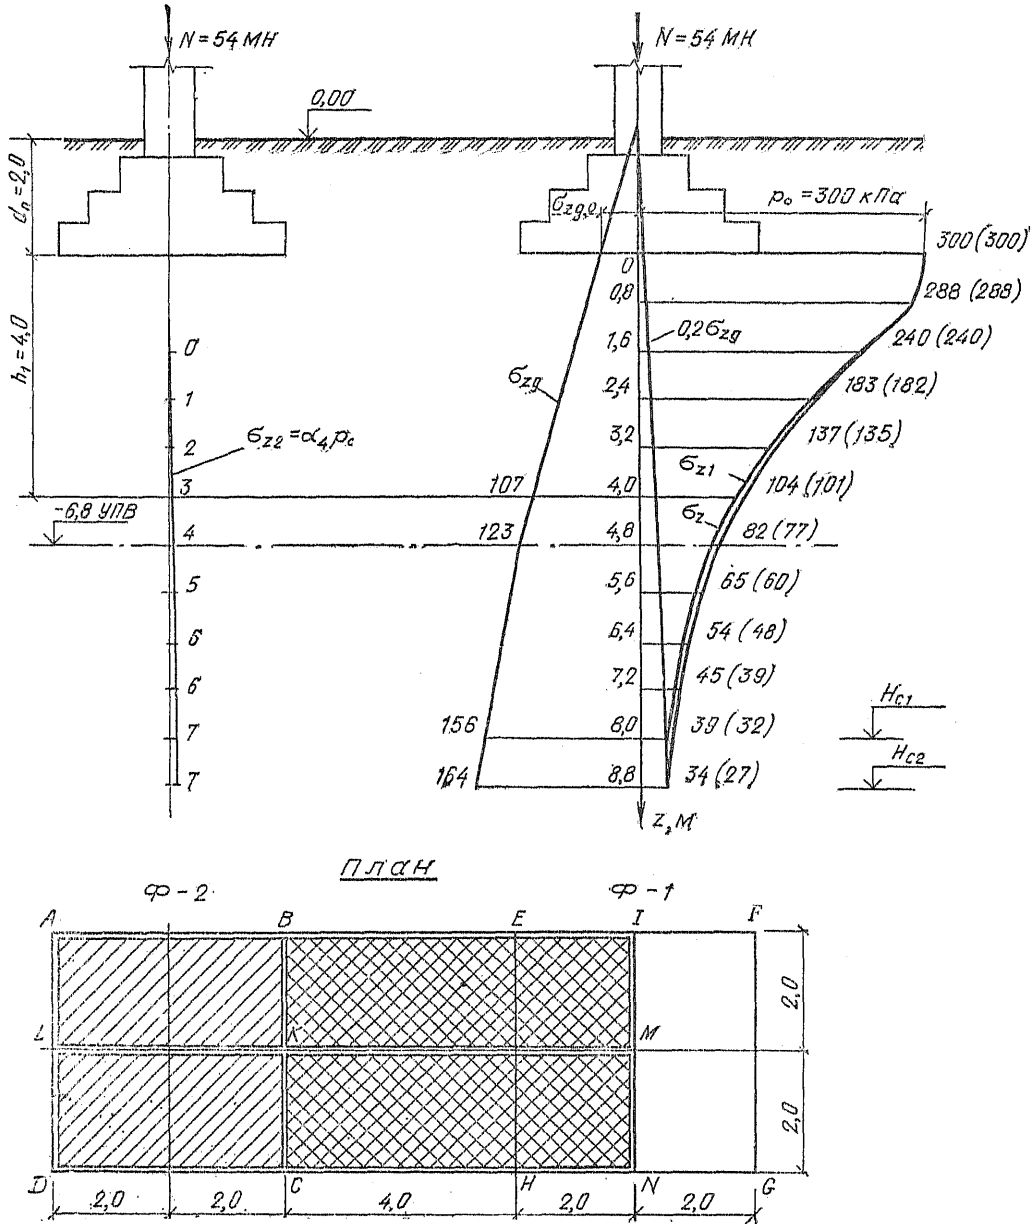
К определению вертикальных нормальных напряжений и расчету осадки фундамента с учетом влияния соседнего фундамента
